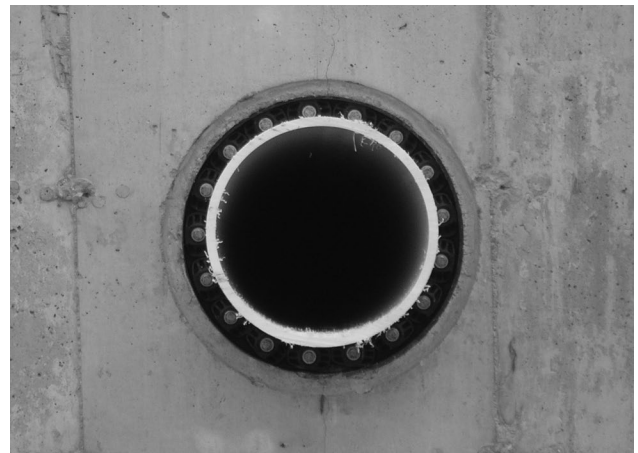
Joint d'étanchéité modulaire traversant un mur de réservoir en béton. Photo : Dietrich Engineering Limited
